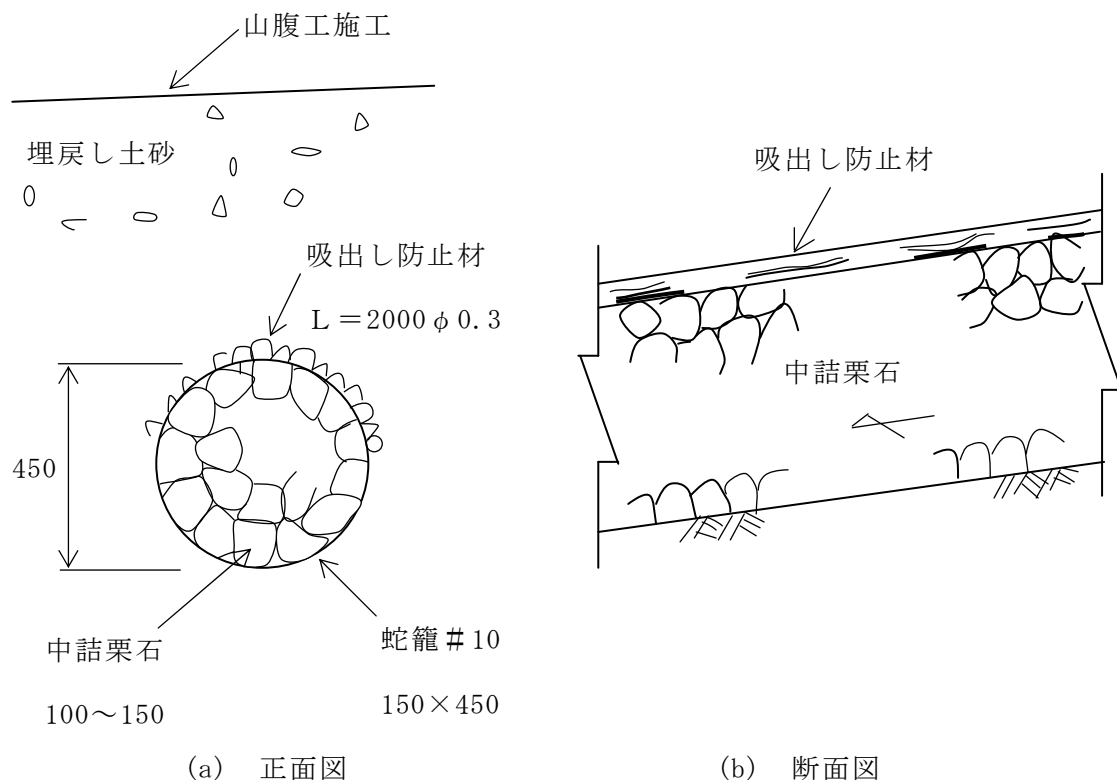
蛇籠暗渠工の例(単位: mm)
